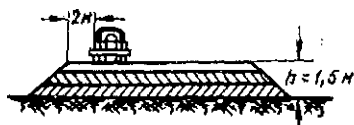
Схема перекрытия ходов катком на пневмоколесном ходу
